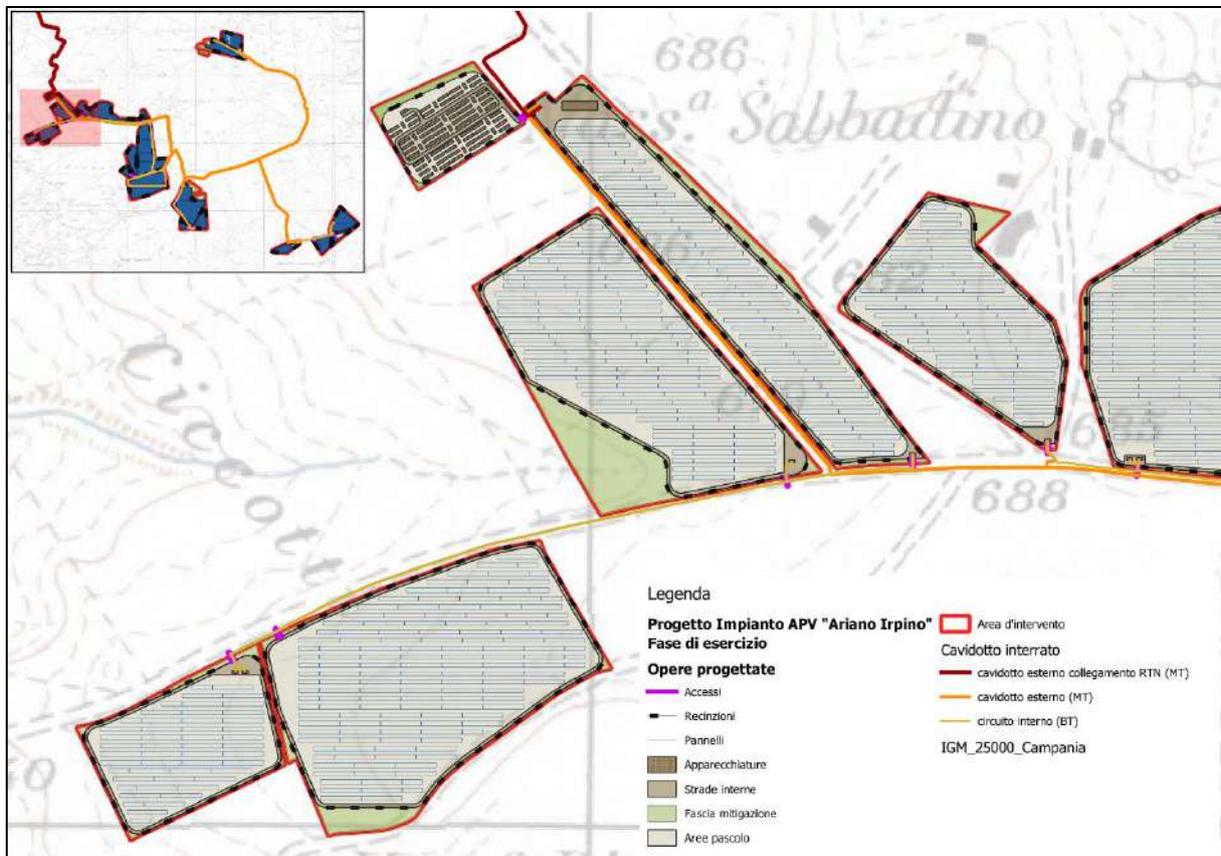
planimetria riportante i campi fotovoltaici in fase di esercizio
